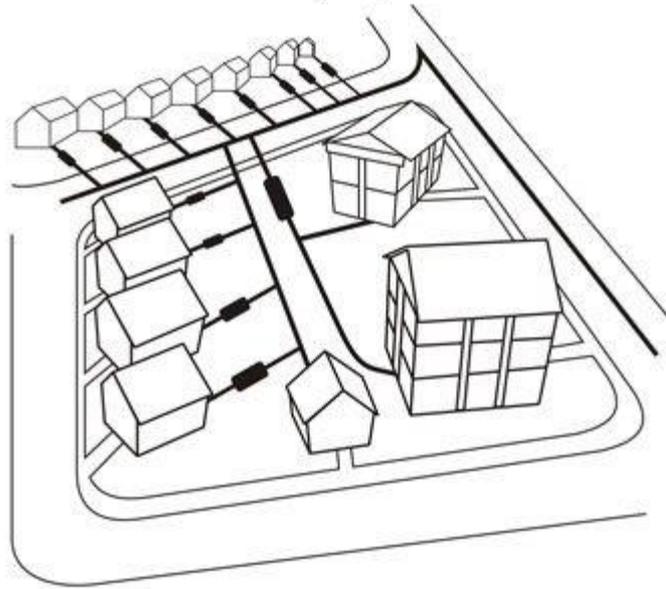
; Esquema de un sistema de alcantarillado condominial
